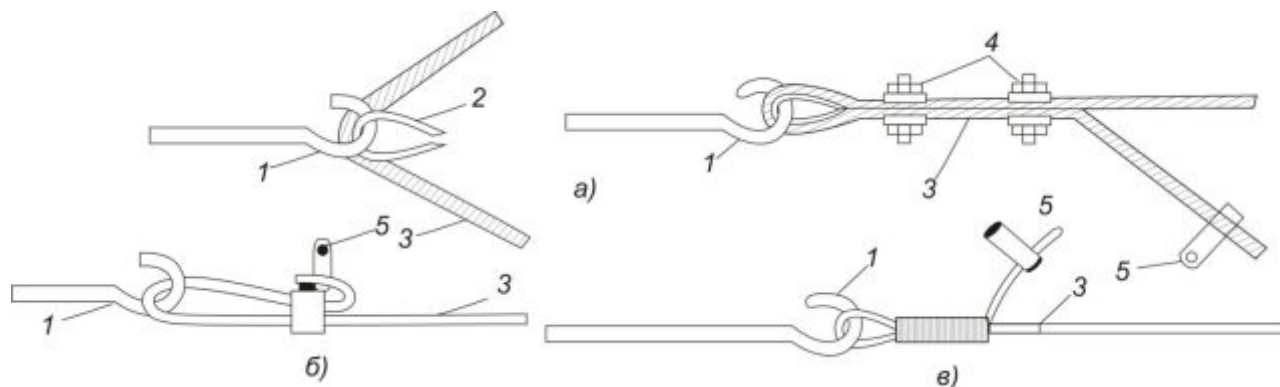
Концевые заделки несущих тросов: а — с помощью коуша и плащечного зажима; б - с помощью стальной обоймы; в — путем закручивания конца проволоки (катанки) в спираль; 1 — крюк; 2— коуш; 3 — трос или проволока (катанка); 4 — зажим плащечный; 5 — наконечник для заземления троса
